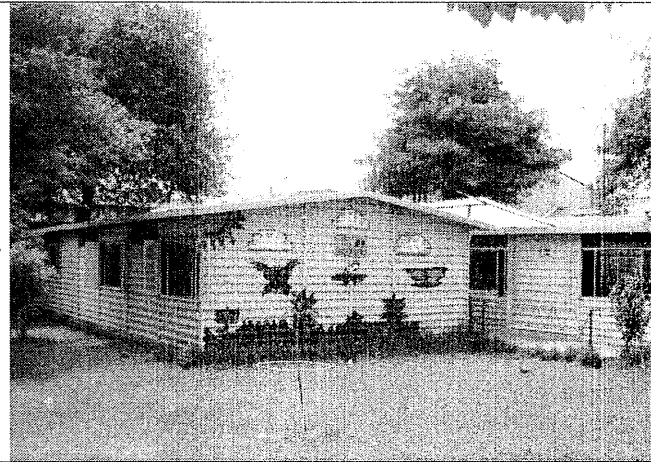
Vista exterior de los salones construidos en paneles de lámina metálica, costado oriental del plantel educativo.
